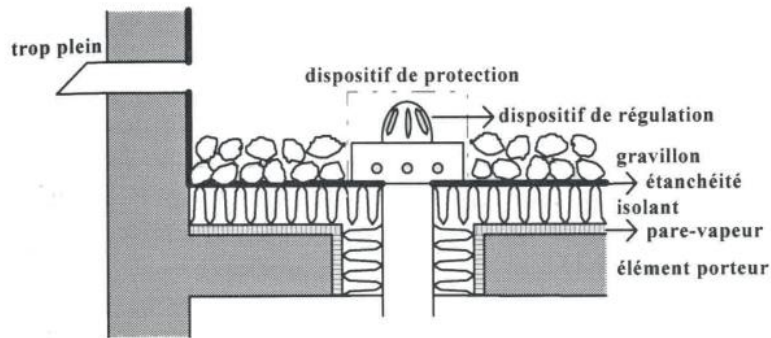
Exemple de constitution d'une toiture terrasse stockante
